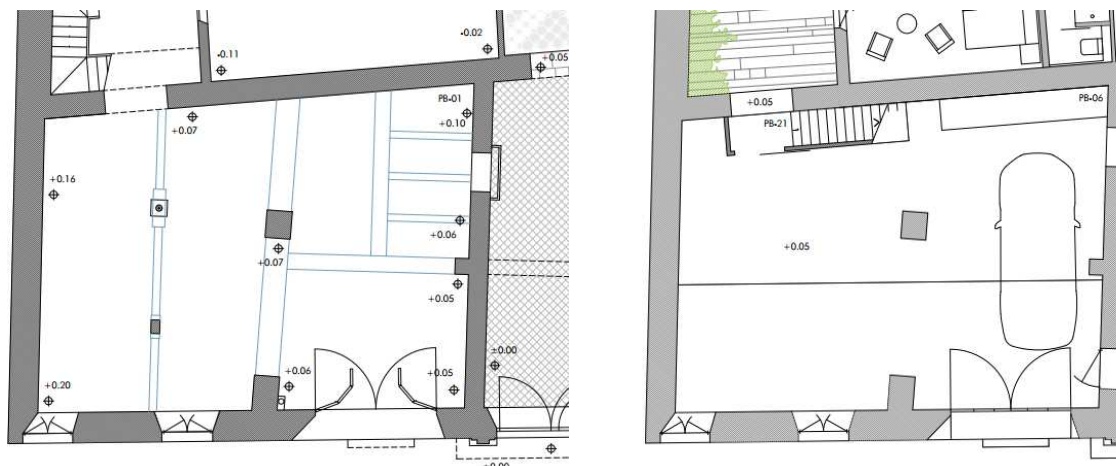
Planta baja. Estado previo (izquierda) y estado reformado (derecha)
